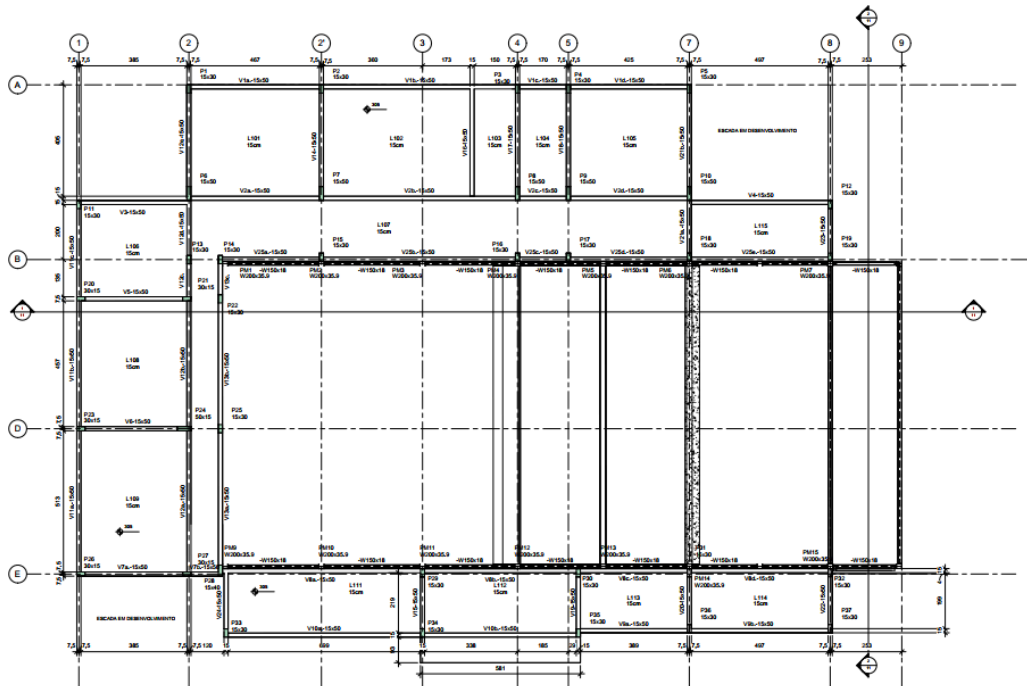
Planta da estrutura metálica e de concreto do teto do térreo do anexo 2 [dimensões em mm; Fonte: Desenho Cerne 0001_07_ET_RE_1006_00].
